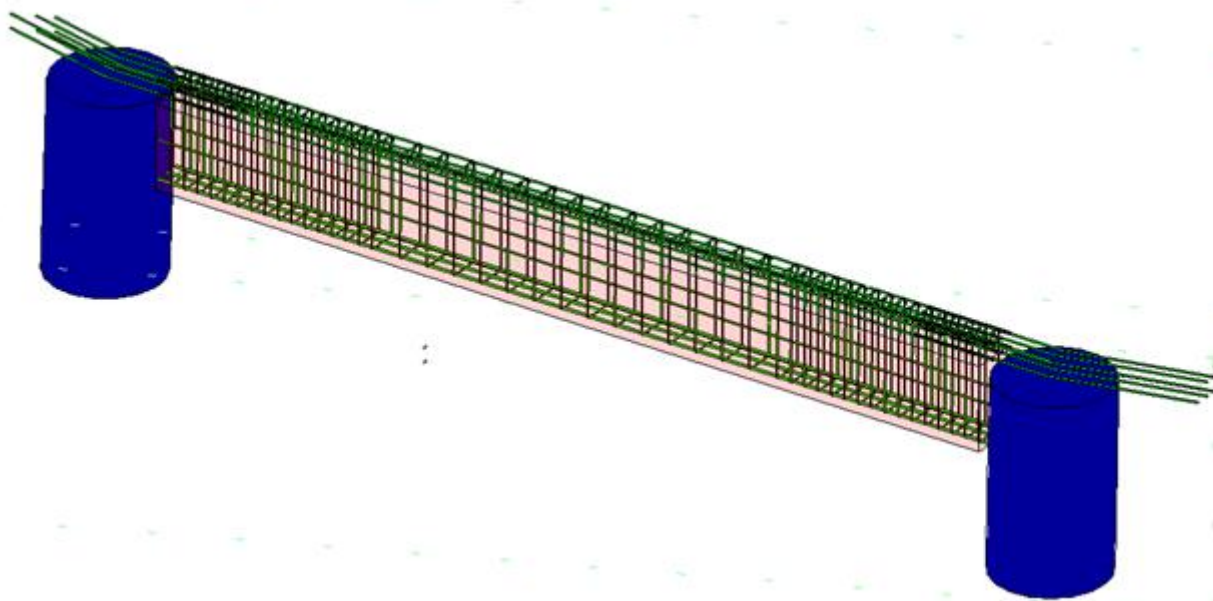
Схема армування монолітної залізобетонної балки
